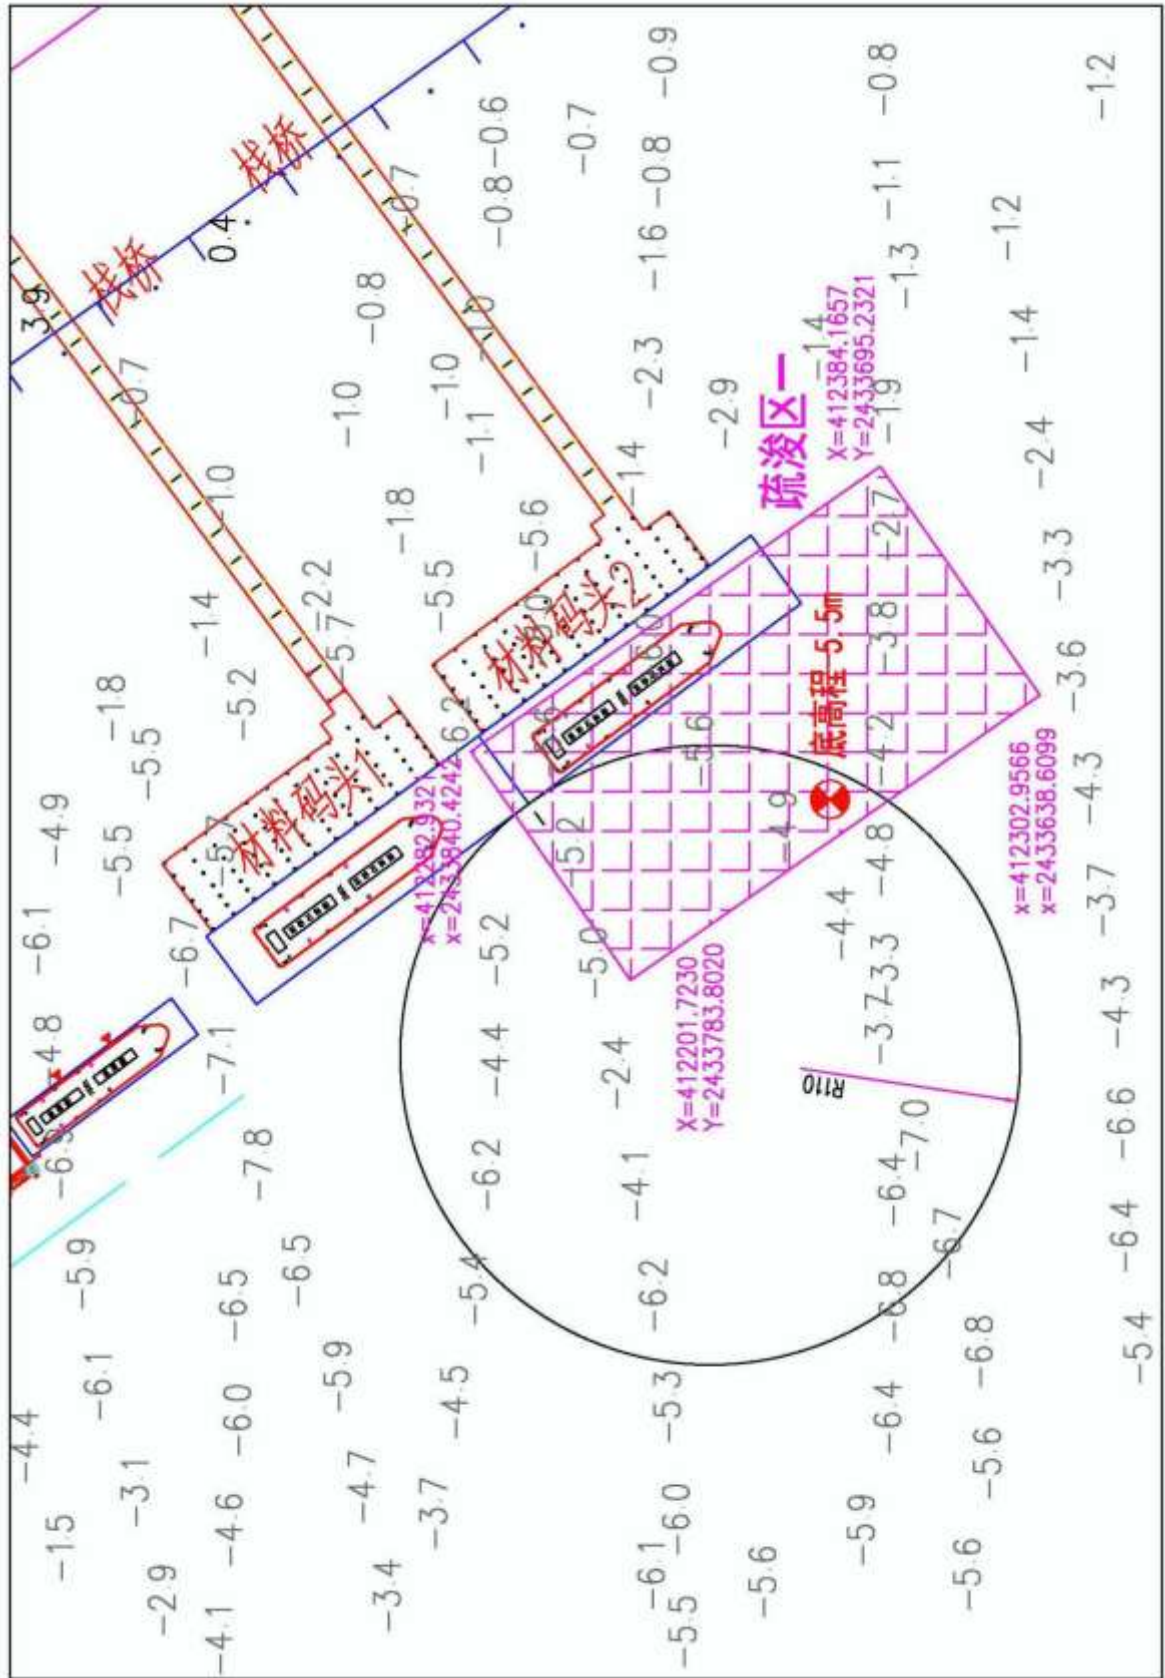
疏浚区一平面图（尺寸单位：m）
